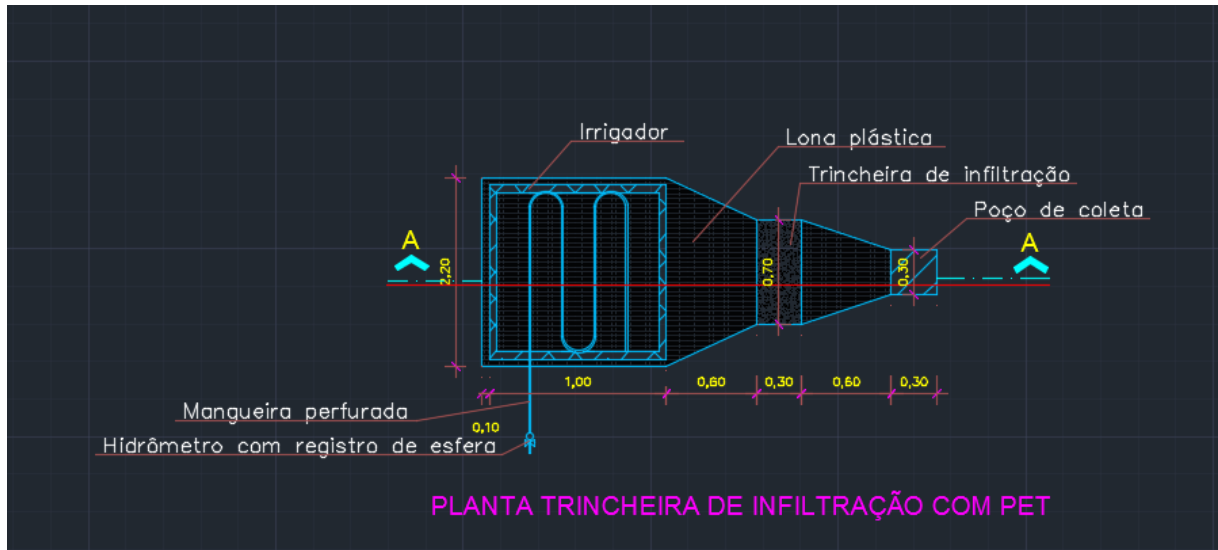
Planta baixa da trincheira de infiltração com garrafa PET
